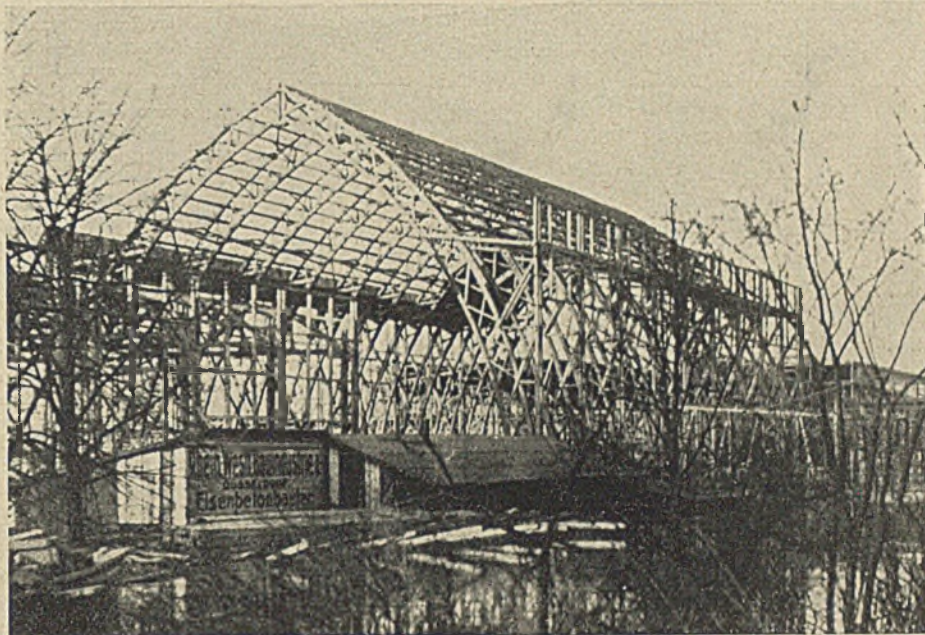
Tragwerk der großen Halle im Hochwasser, Neujahr 1926.
